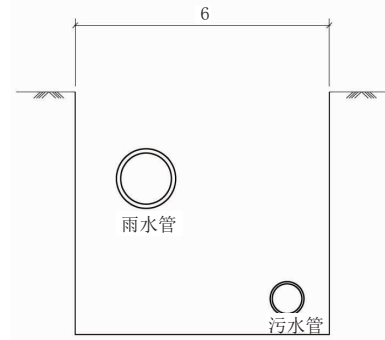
钢板桩支护、雨污水同槽施工方案(单位:m)
